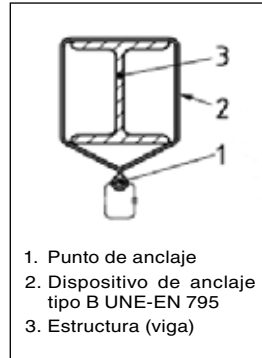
Dispositivos de anclaje Tipo B anclado a una viga.
